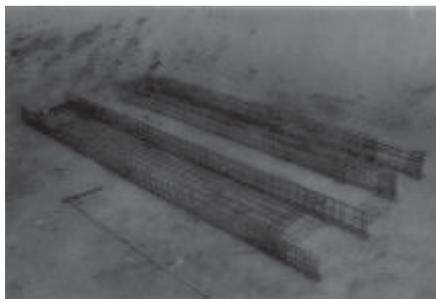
Armaduras dos pré-moldados para revestimento de canal - Peça do fundo - esquerda e peça lateral - direita
